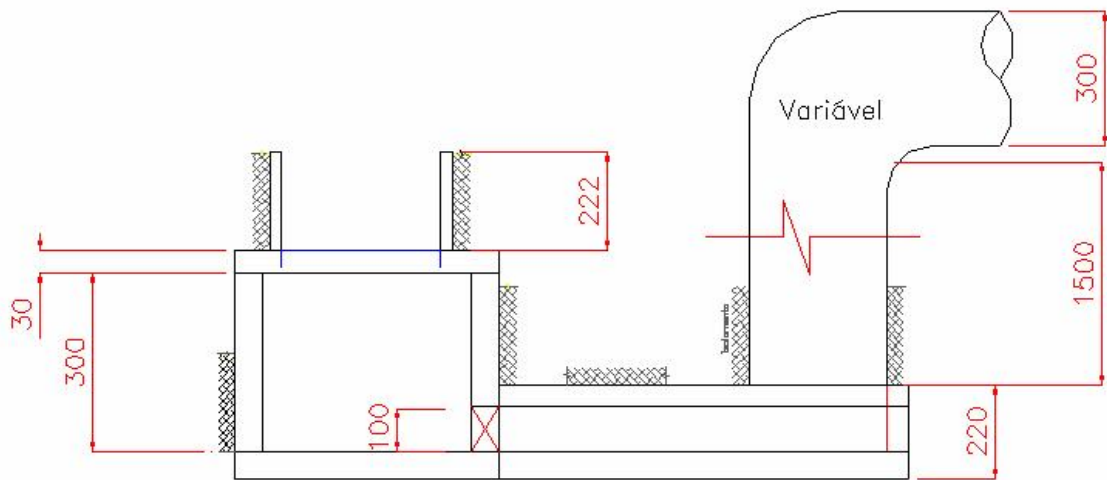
VISÃO LATERAL DA FORNALHA (dimensões em mm)
